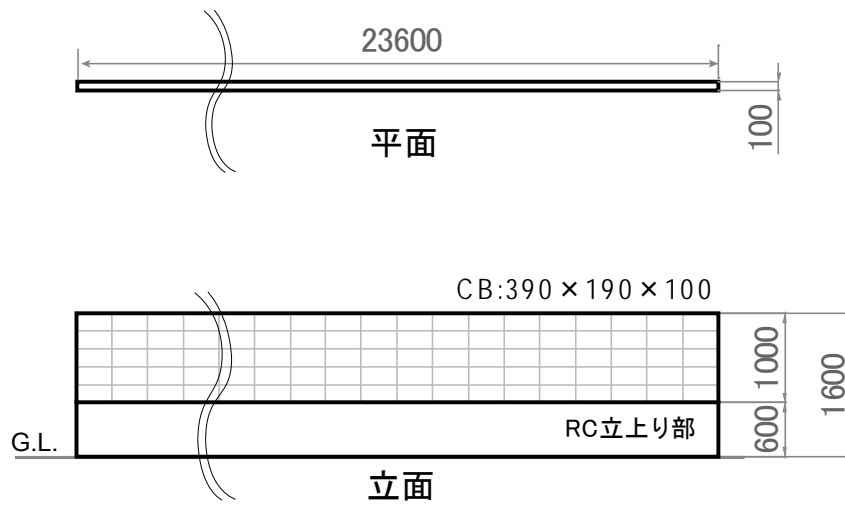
岡田桶前地区のCB塀 立面・平面図 (単位: mm)
